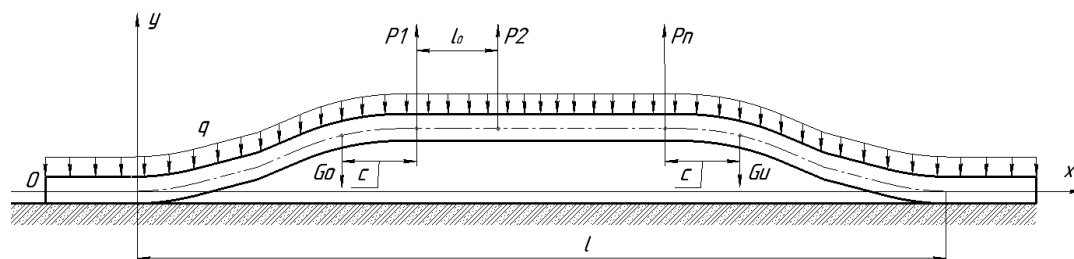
Расчетная схема подъема трубопровода при капитальном ремонте
